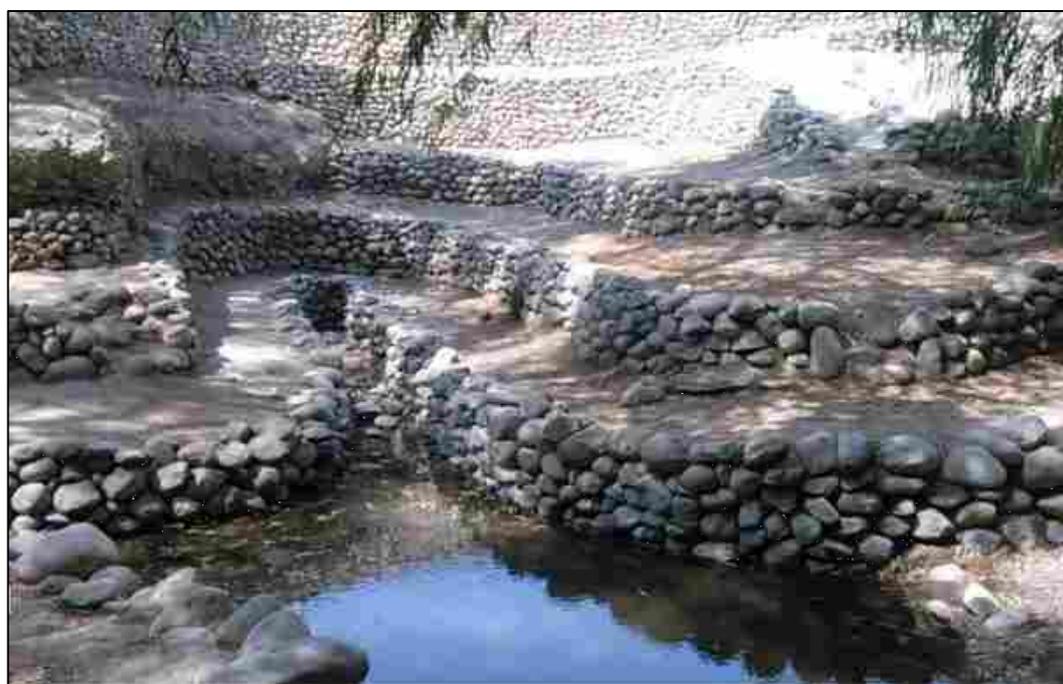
Acueducto de Achaco, detalle de los muros con piedras, casi sin argamasa. Se hace a niveles para para permitir el acceso a varios metros de profundidad.
